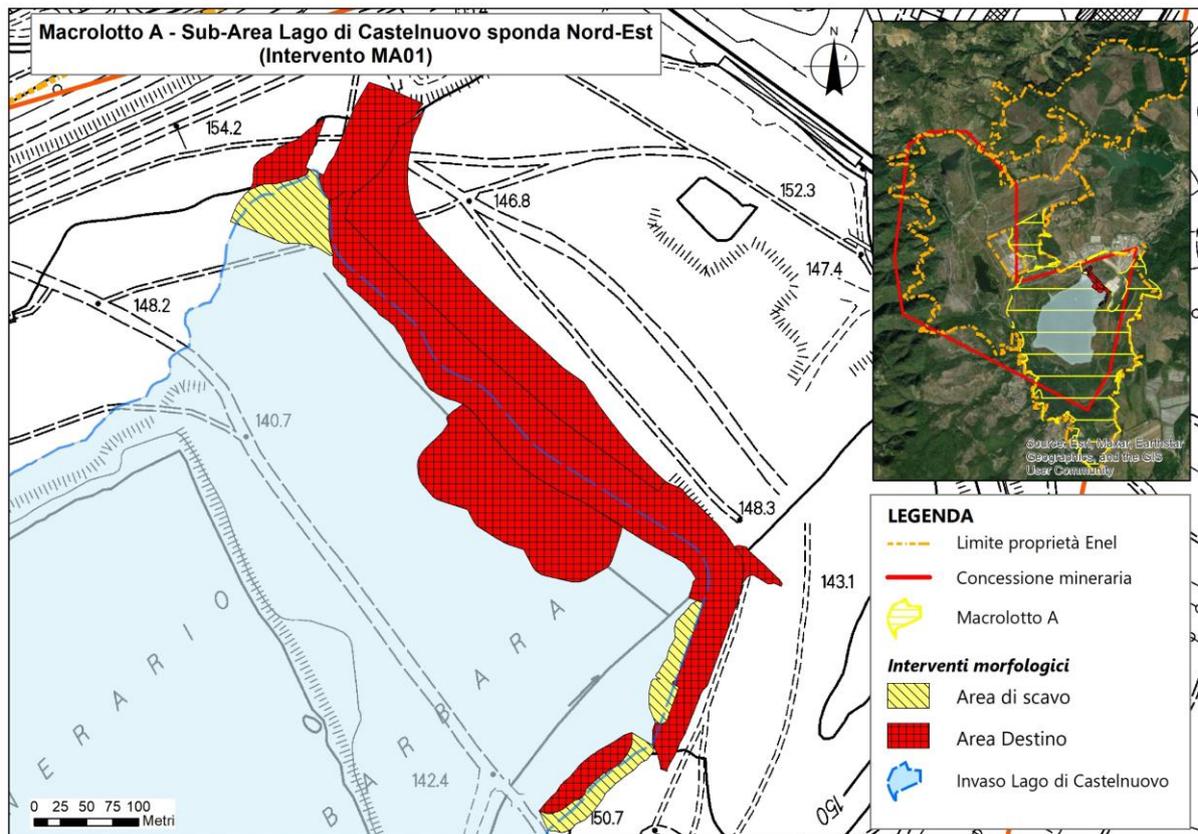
MA-01 - Lago Castelnuovo sponda Nord-Est: ubicazione dell'area d'intervento.
